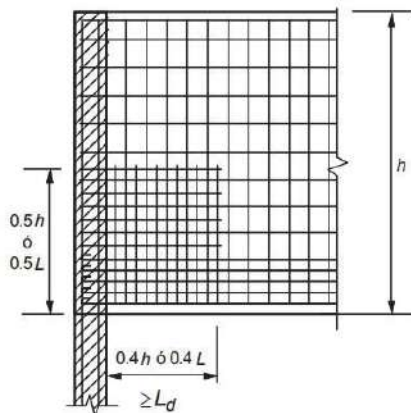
Refuerzo en una zona de apoyo indirecto
